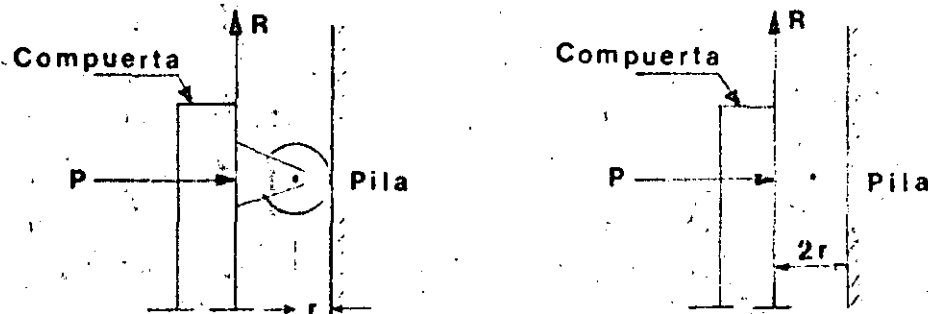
Rodillos unidos a la compuerta y entre compuerta y pila.
